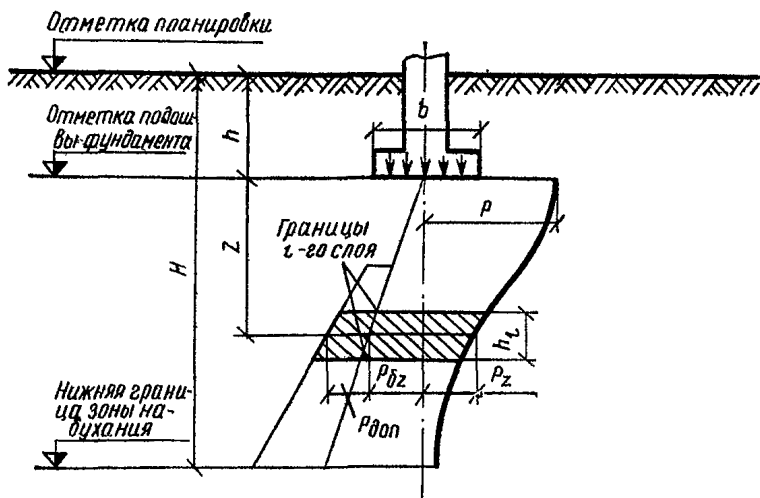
(рис. 5 прил. 3). Схема для расчета подъема оснований при набухании грунта
